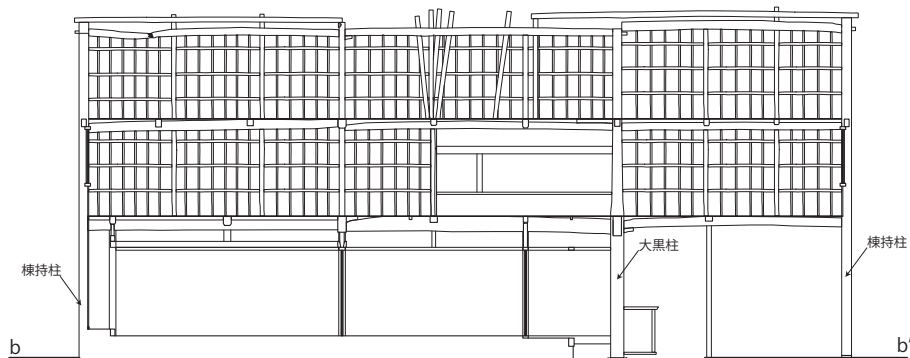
今井秀郎家住宅 桁行断面図 1/150
